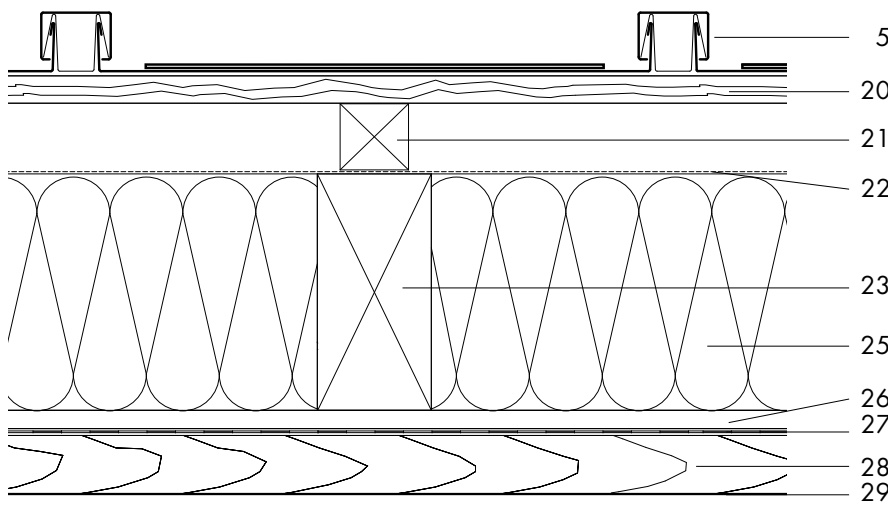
Belüfteter Dachaufbau mit RHEINZINK-Klick-Leistensystem
